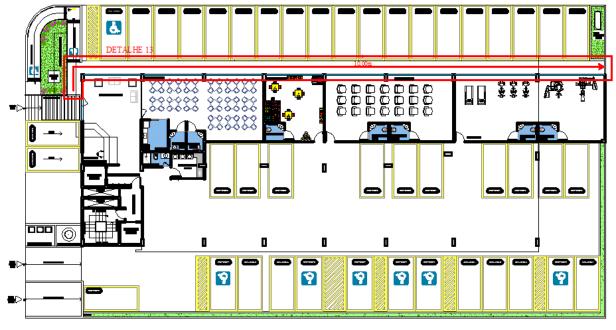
Planta Baixa - Pavimento térreo (4)
